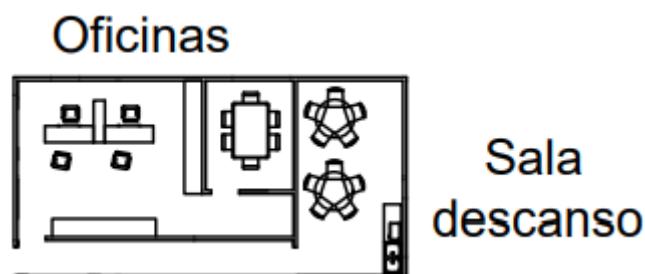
Croquis planta superior altillo secadero, propuesta 1.
